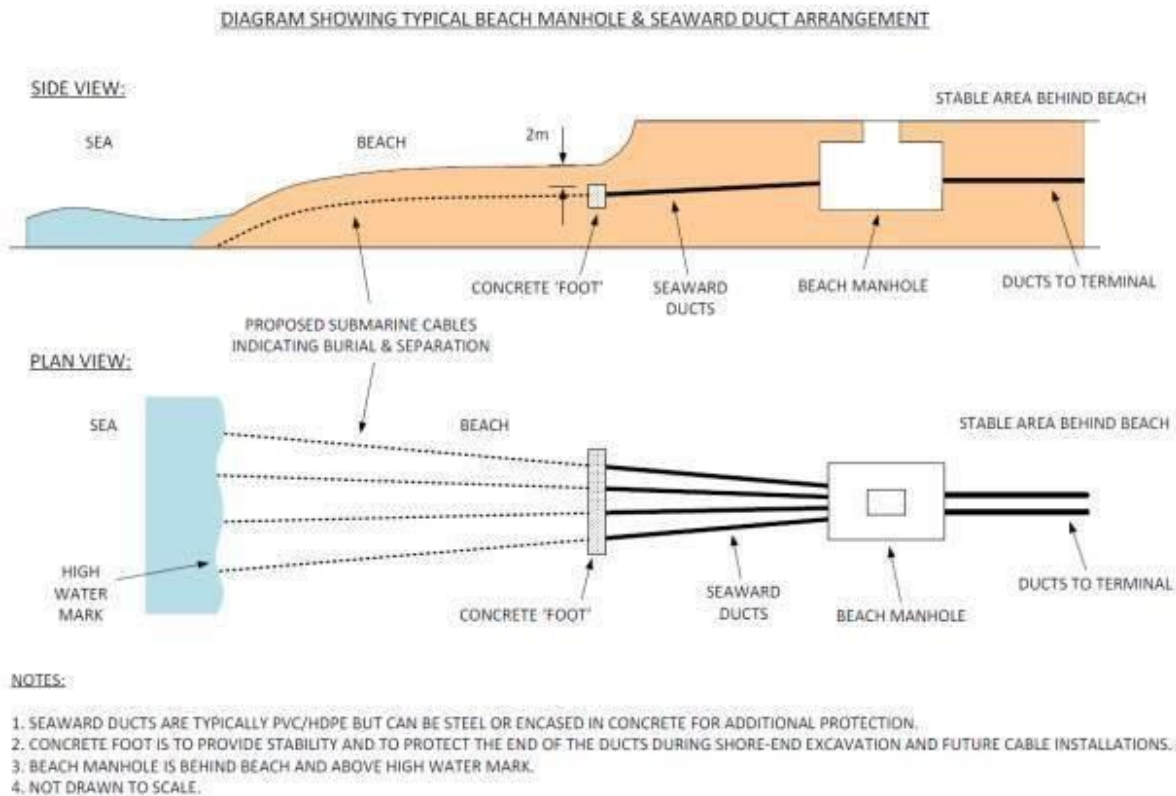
Schéma type d'installation d'un chambre-plage et de conduites (source TIS 2021)
